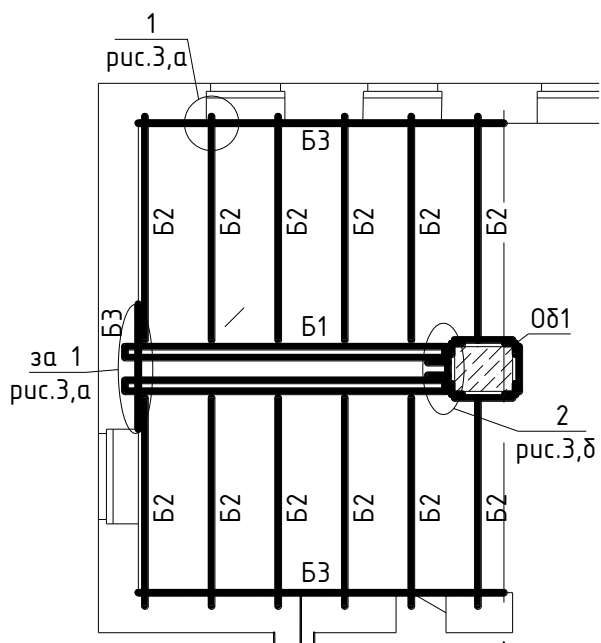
Фрагмент розкладки сталевих балок нового сталезалізобетонного перекриття над підвальним приміщенням
